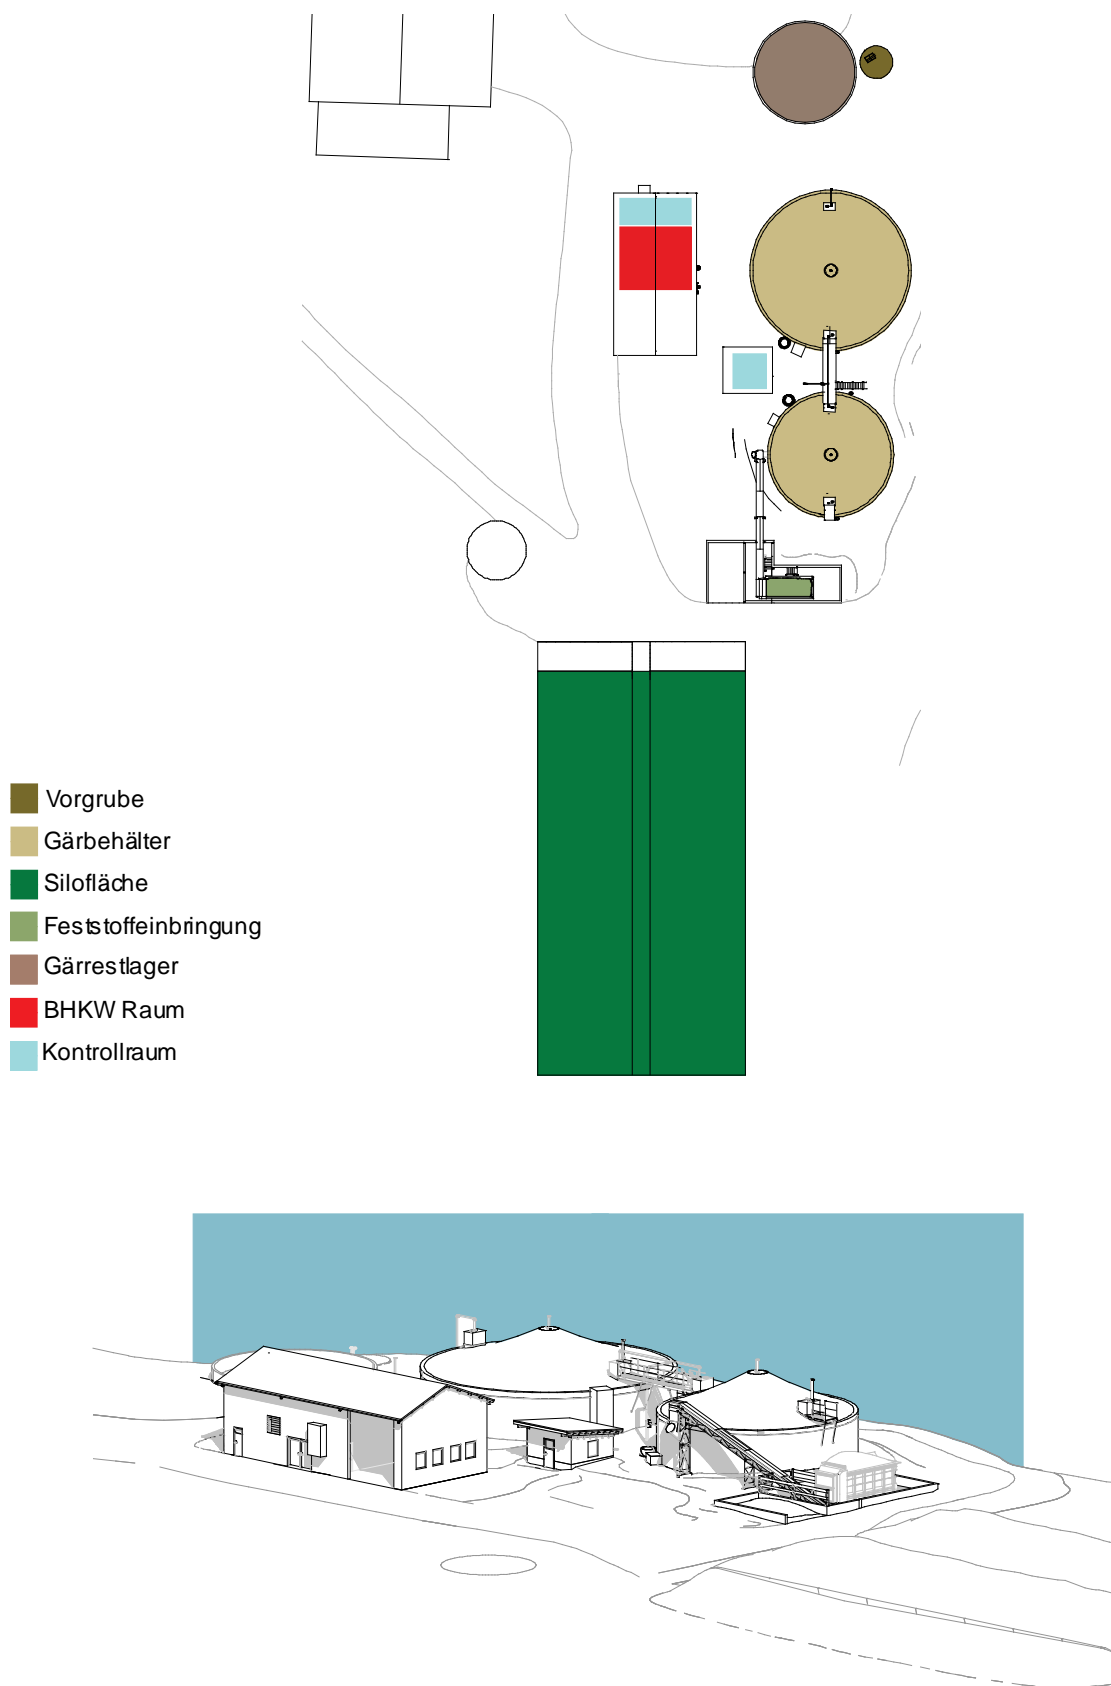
Grundriss und isometrische Darstellung der Pilotanlage 13
